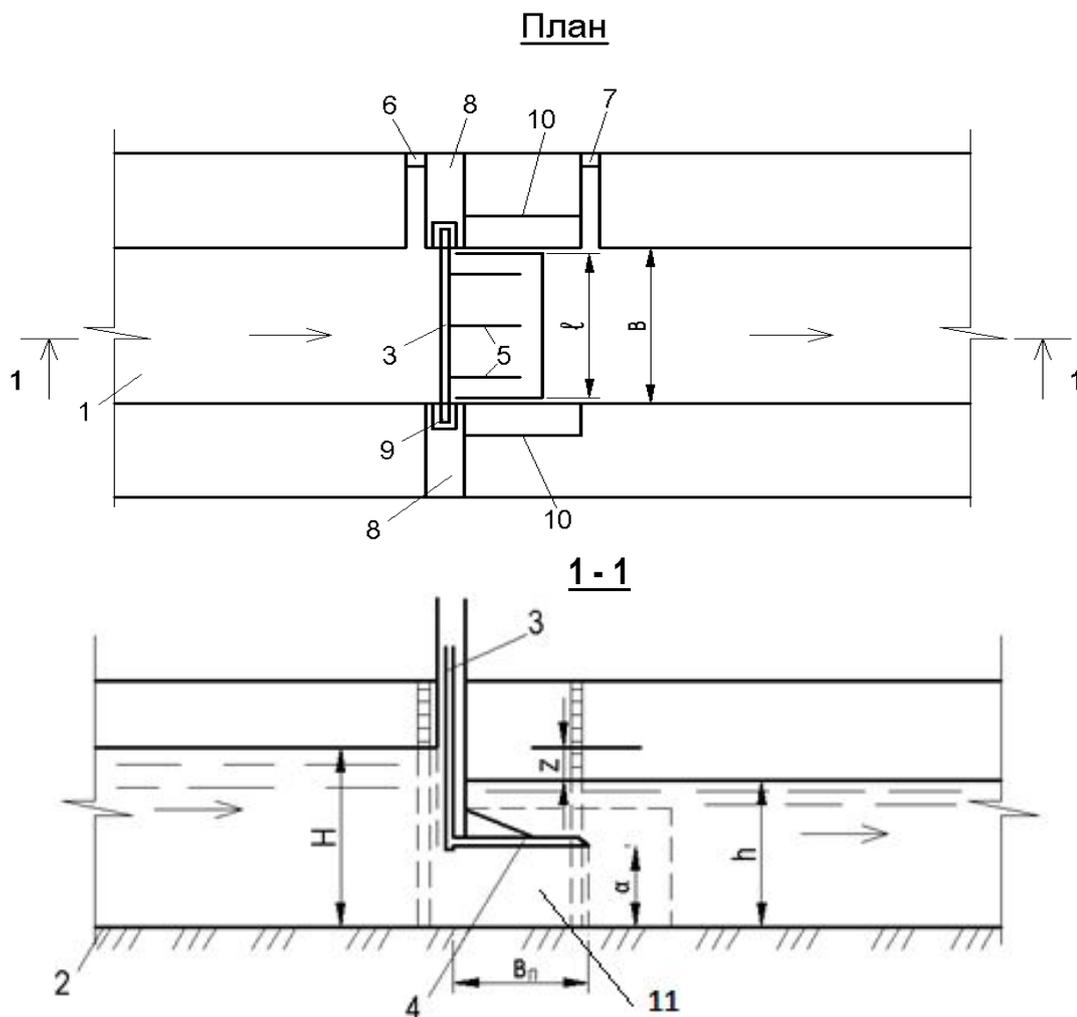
Схема водомера типа «Прямоугольный насадок» применительно к водотоку с трапецидальным сечением
